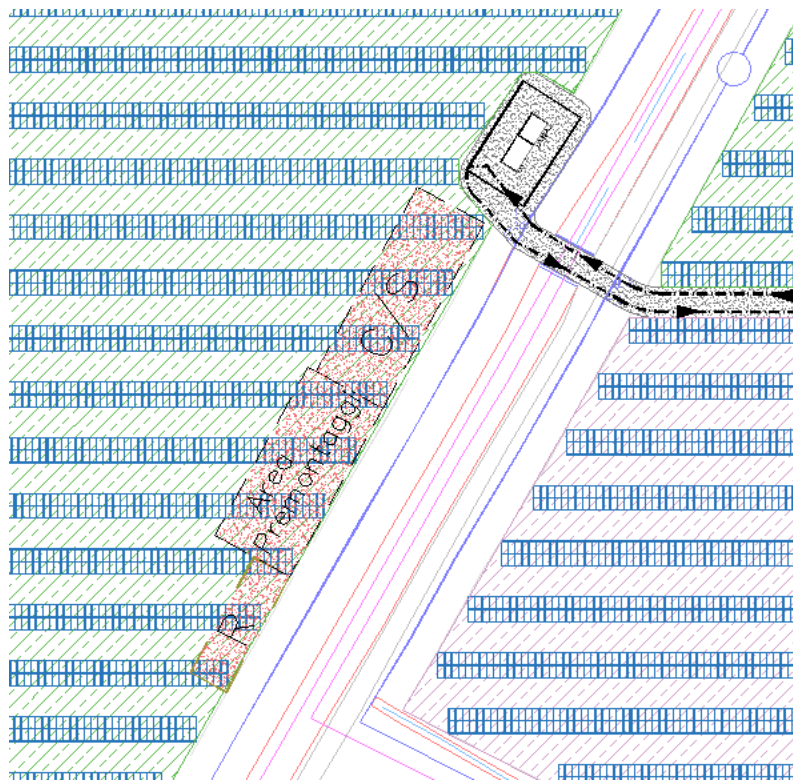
Dettaglio area di accantieramento "Ozzano 5"
